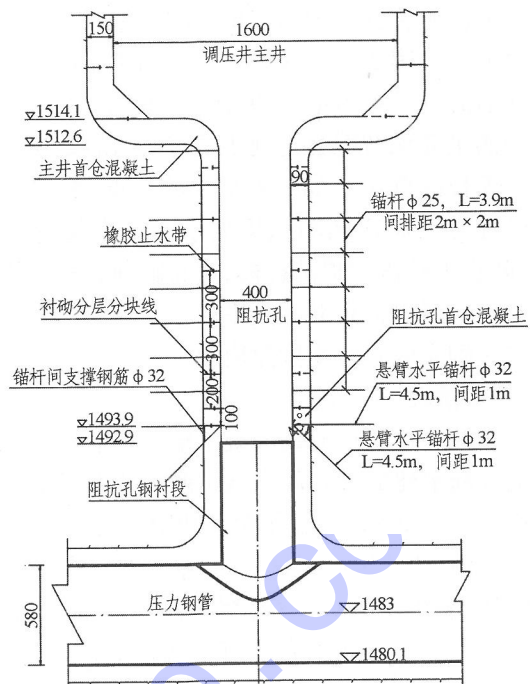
调压井阻抗孔衬砌施工布置图 单位:cm
